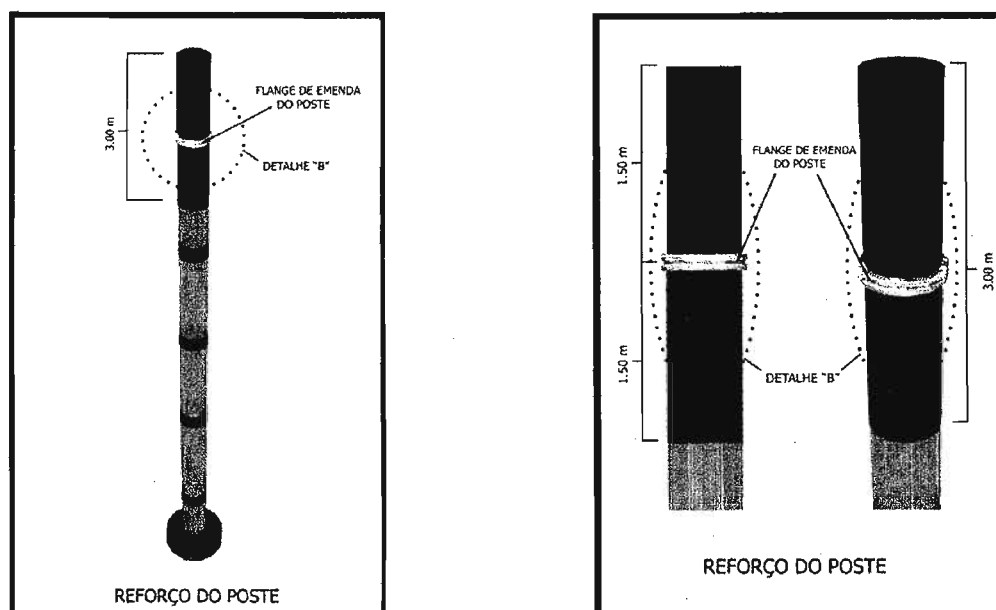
Esquema do reforço proposto e aprovado para a região do traspasse dos postes de concreto centrifugados.
